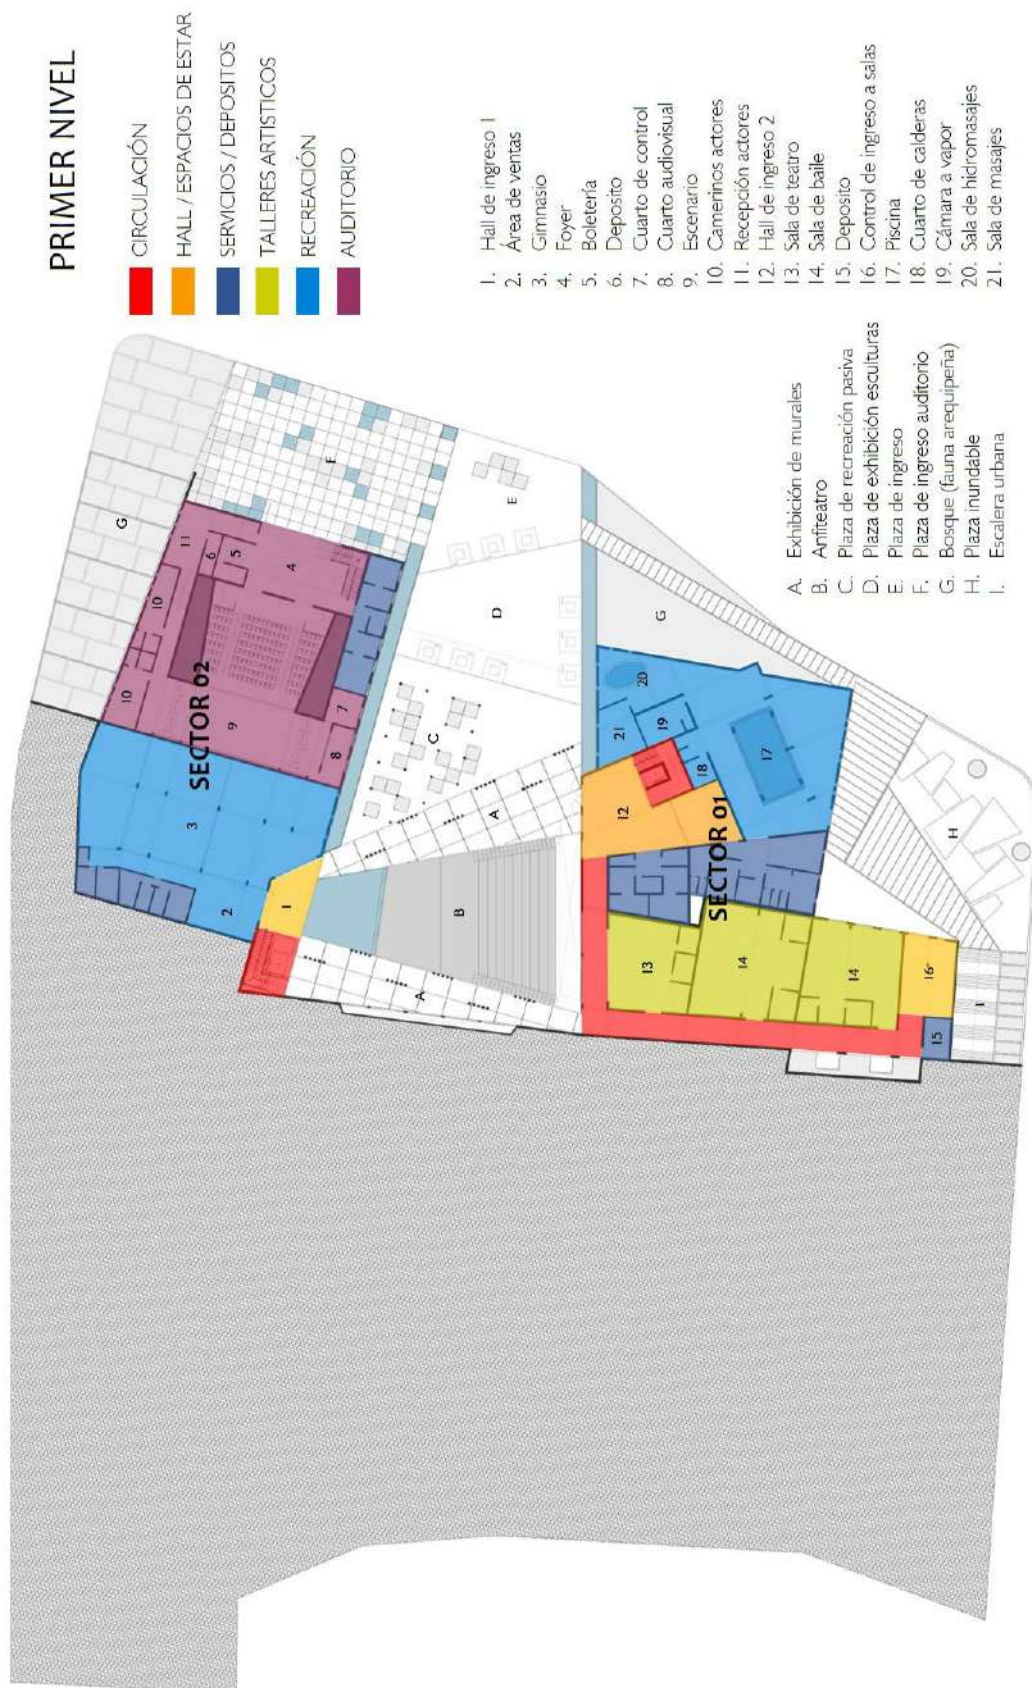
Zonificación del conjunto arquitectónico – Primer nivel.
